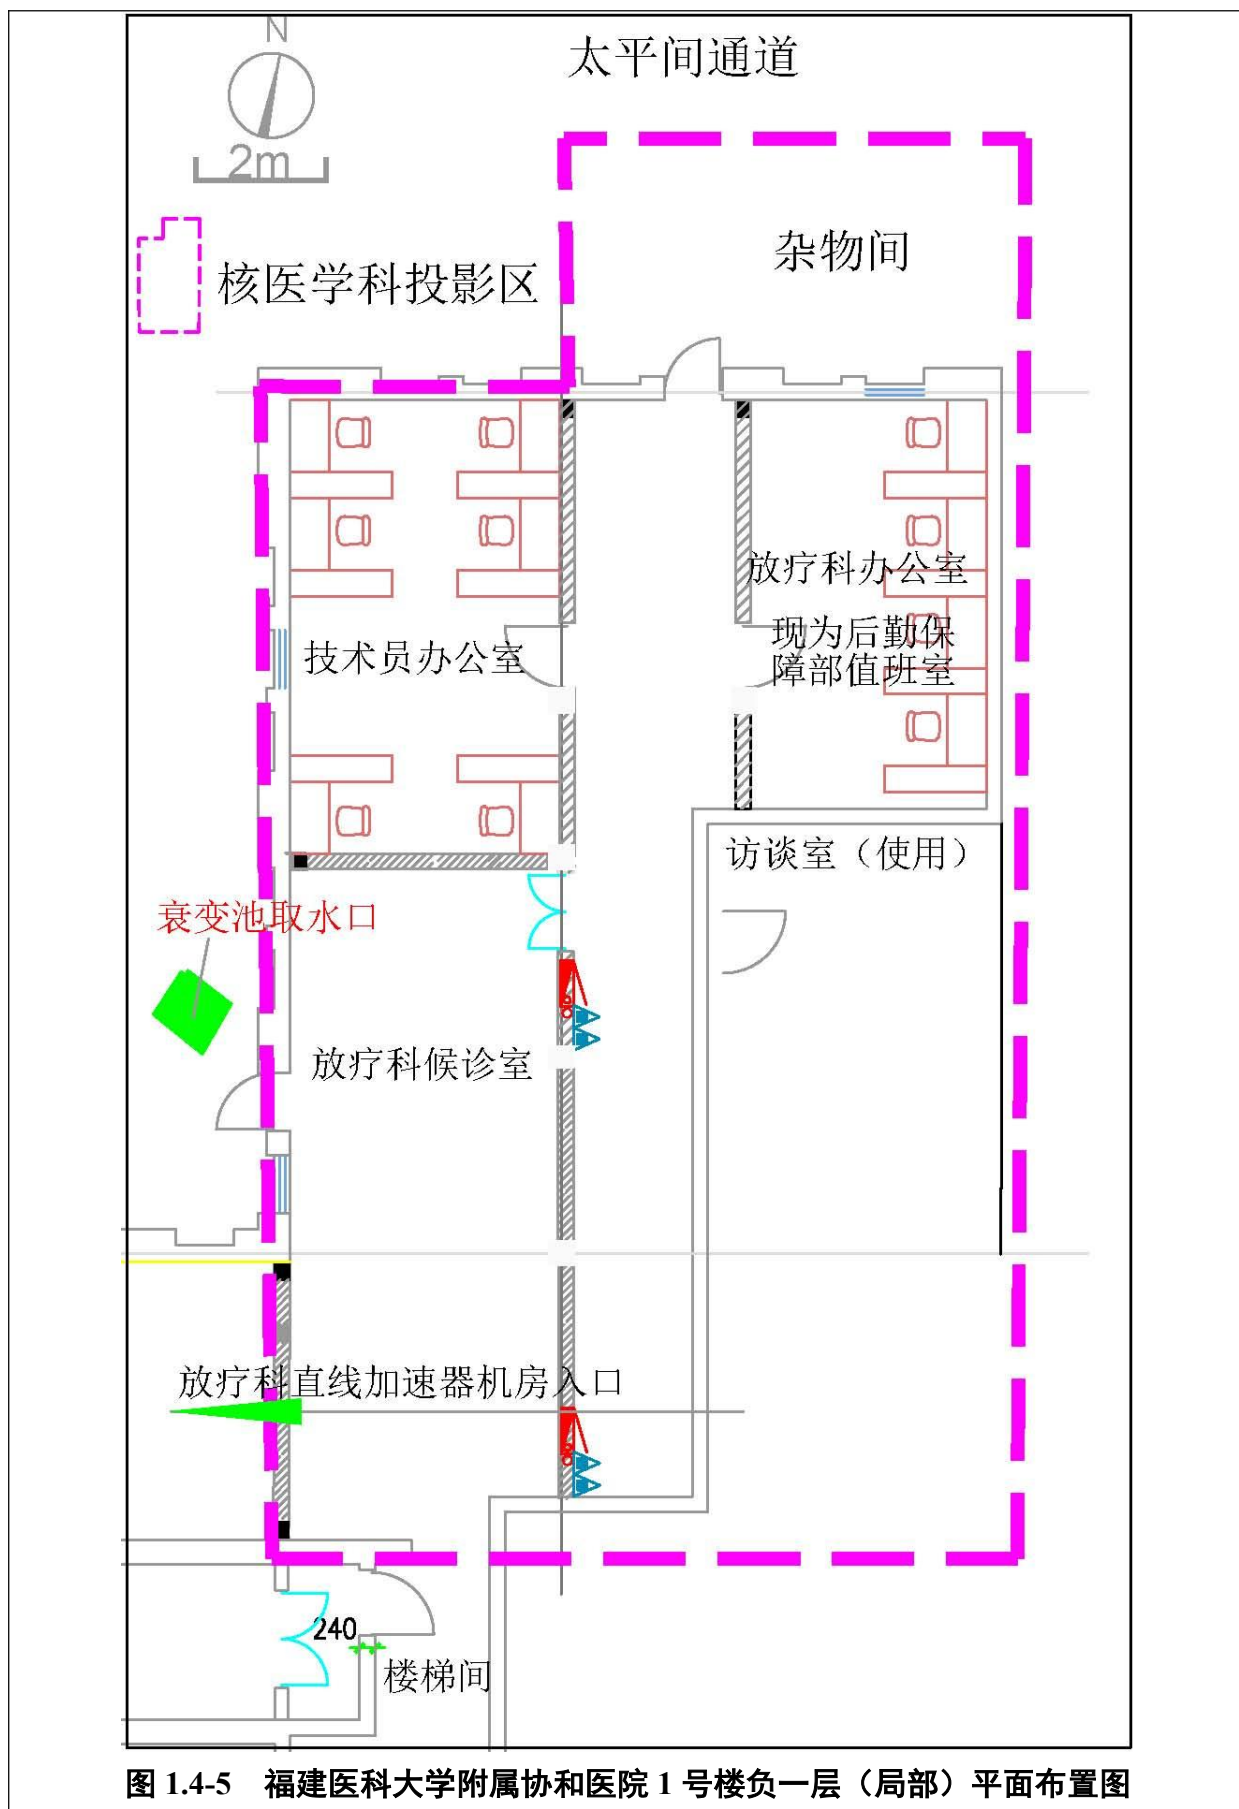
福建医科大学附属协和医院 1 号楼负一层（局部）平面布置图
